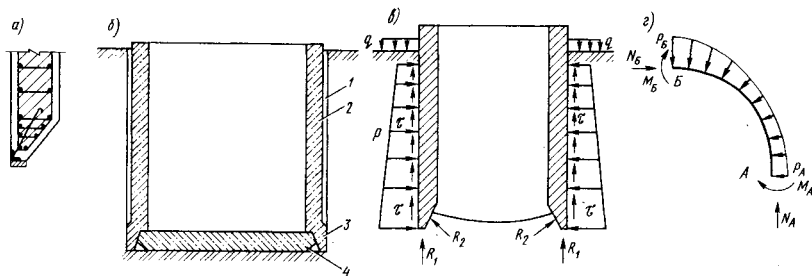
Конструктивные детали и нагрузки, действующие на колодец: а — конструкция ножа; б — сборный опускной колодец; в — нагрузки, действующие на колодец во время погружения; г — опоры неравномерного давления грунта на боковой поверхности при «завале» на грунт во время неравномерного погружения; 1 — шель, заполняемая раствором бентонитовой глины; 2 — бетонная стенка; 3 — нож из сварной стали; 4 — железобетонное днище колодца
